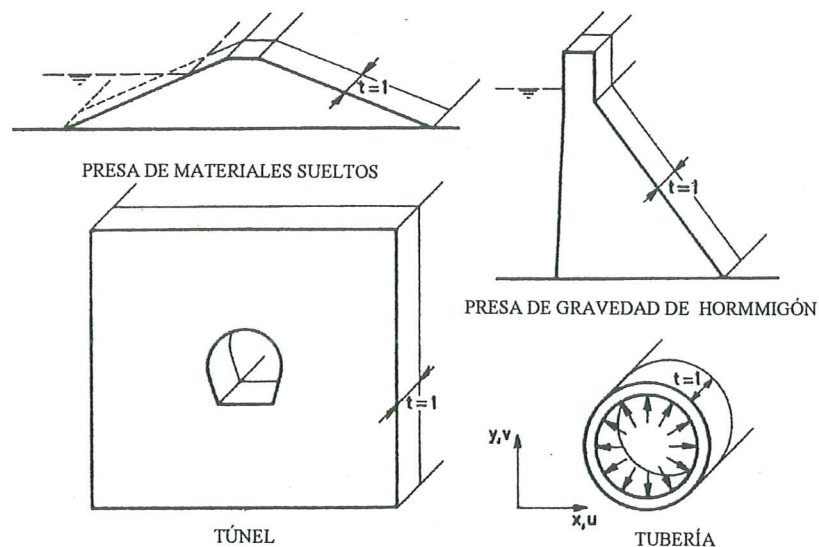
Ejemplo de estructuras sometidas a deformación plana
